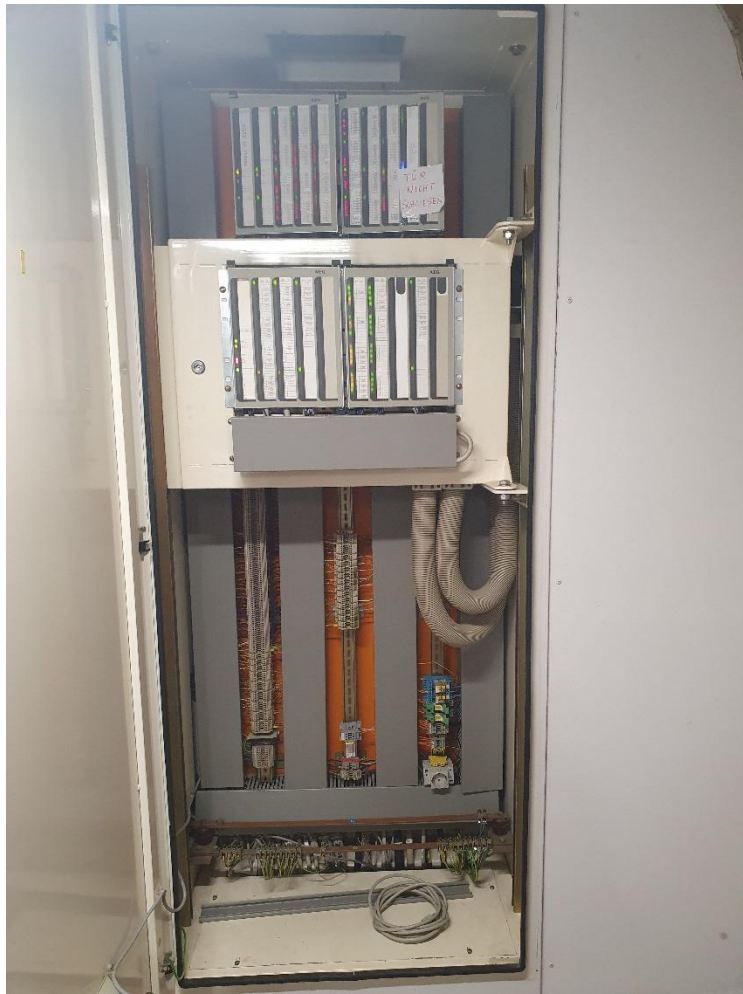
Innenansicht SPS-Schrank UV 1 Feld 2 mit SPS-Hardware auf Baugruppenträger (BGT) 1 + 2
